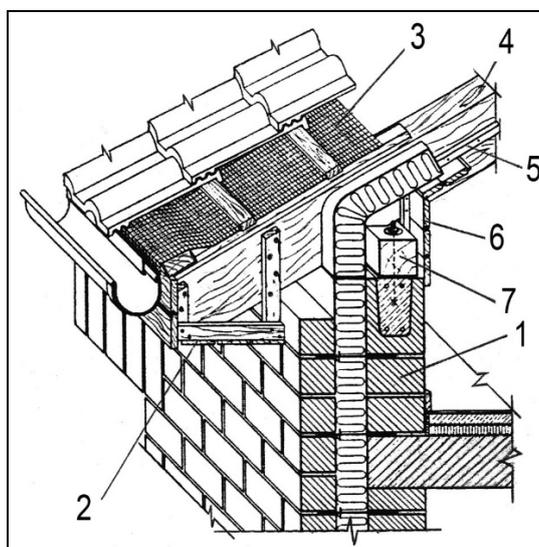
Карнизный узел крыши дома с применением стеновых материалов KS-Mauerwerk; 1 – наружная трехслойная стена со средним слоем из эффективного утеплителя, 2 – подшивка из досок с вентиляционными отверстиями, 3 – вентилируемая воздушная прослойка, ограниченная снизу гидроизоляционным материалом, 4 – стропильная нога, 5 – рейки для крепления потолочной обшивки, 6 – потолочная обшивка из шпунтованных досок, или вагонки, 7 – мауэрлат
